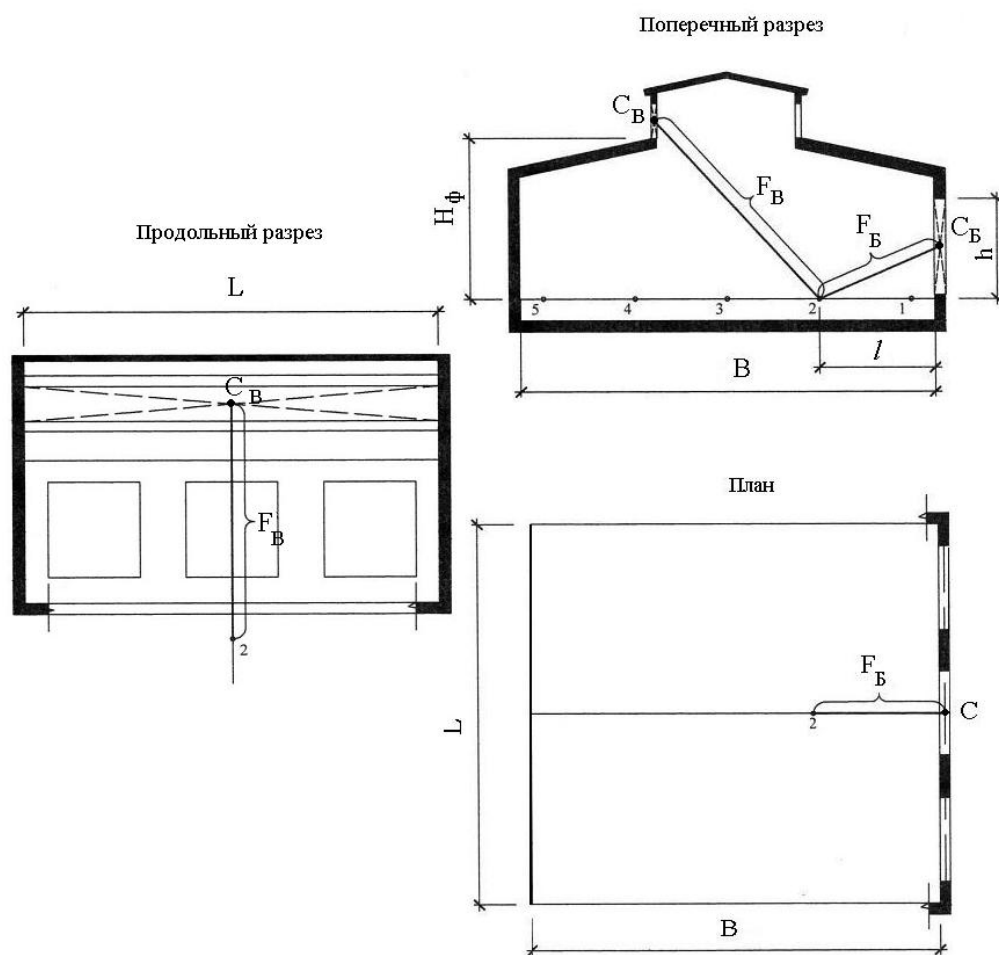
Выбор расчетных точек на характерном разрезе. Перенос точек на план и продольный разрез (на примере точки 2)
